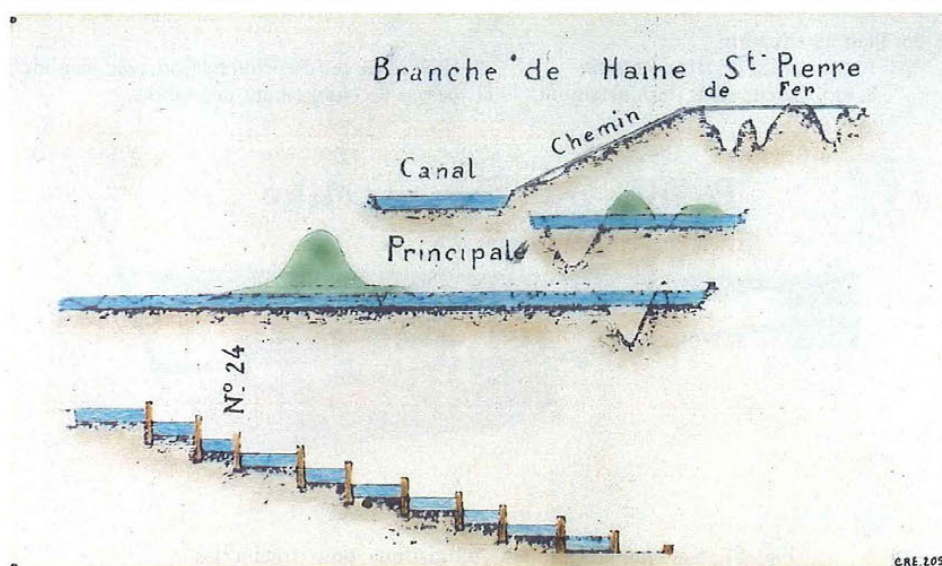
Embranchement de l'ouest ou encore dit de Haine-St-Pierre.
